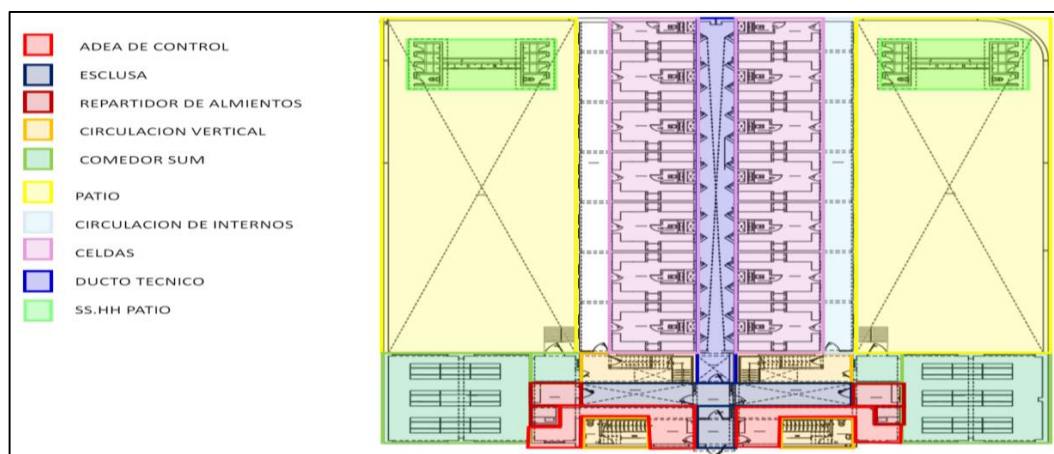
Planta 1er piso del pabellón mediana - Varones
